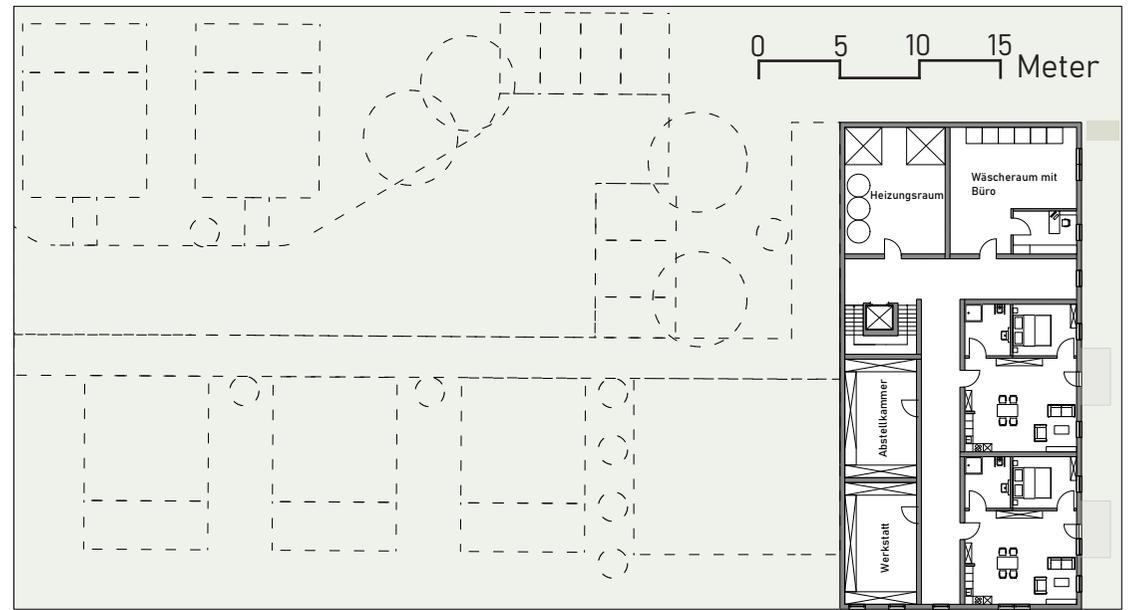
Grundriss UG (V2 Mischbauweise)
